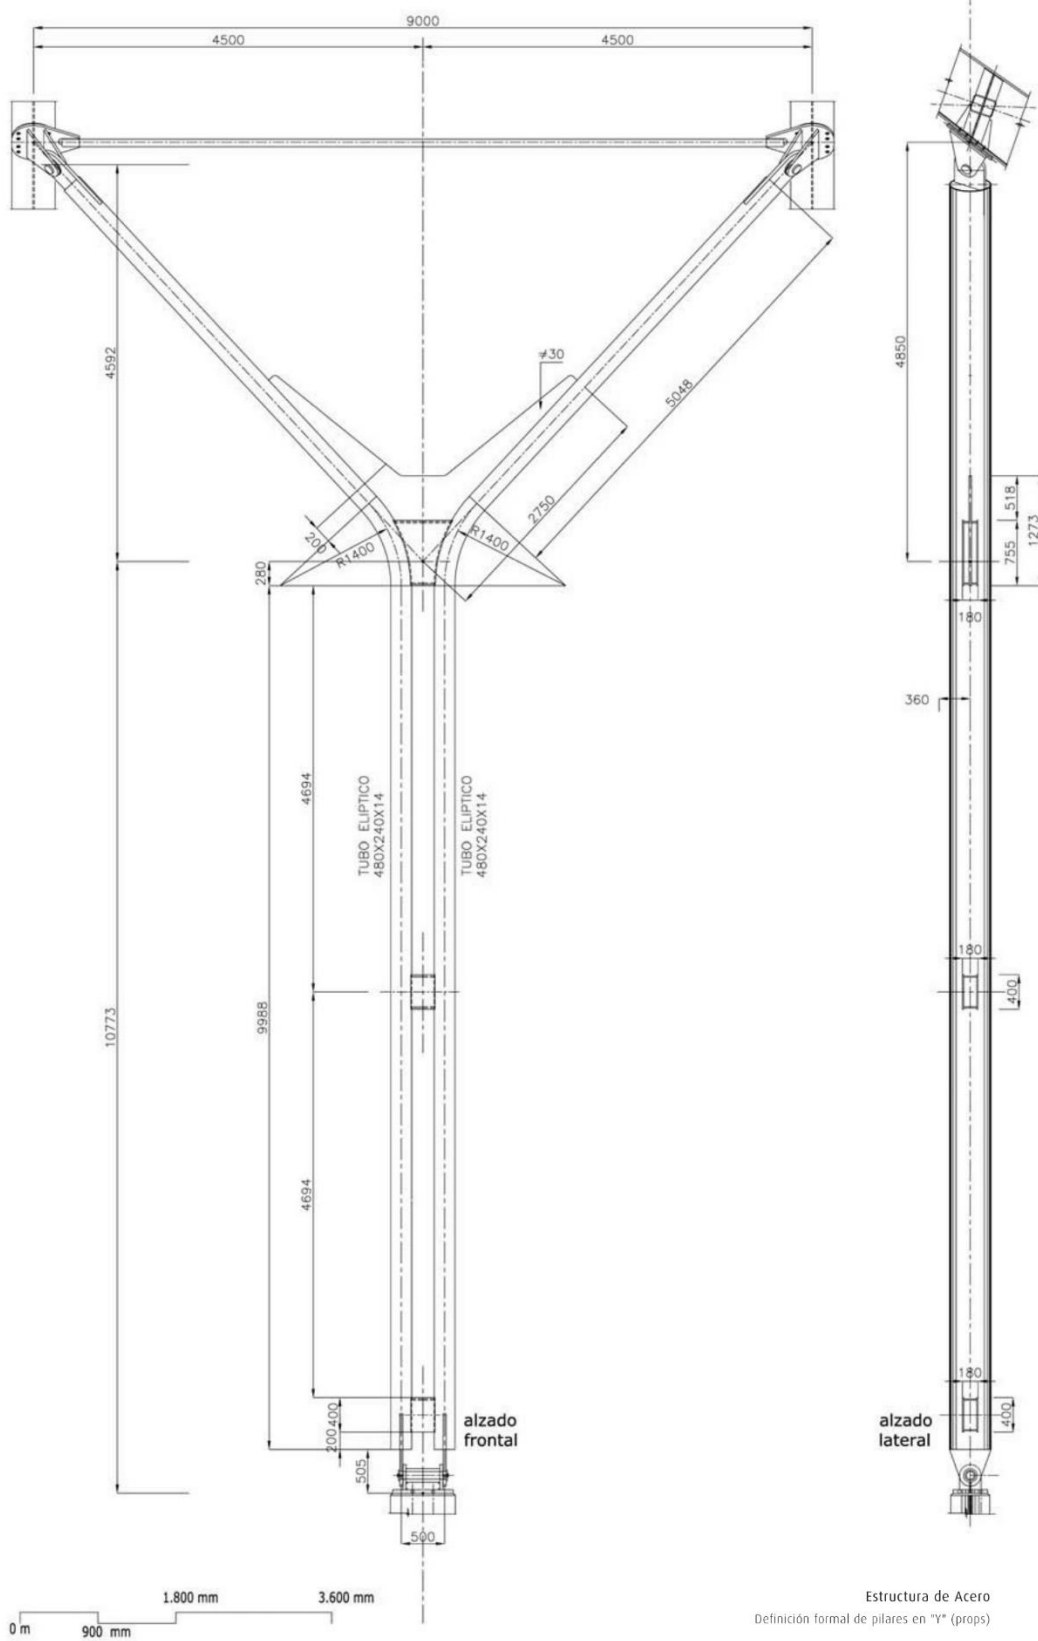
| Alzado frontal y alzado lateral acotados de un pilar en forma de "Y". (TC Cuadernos)
